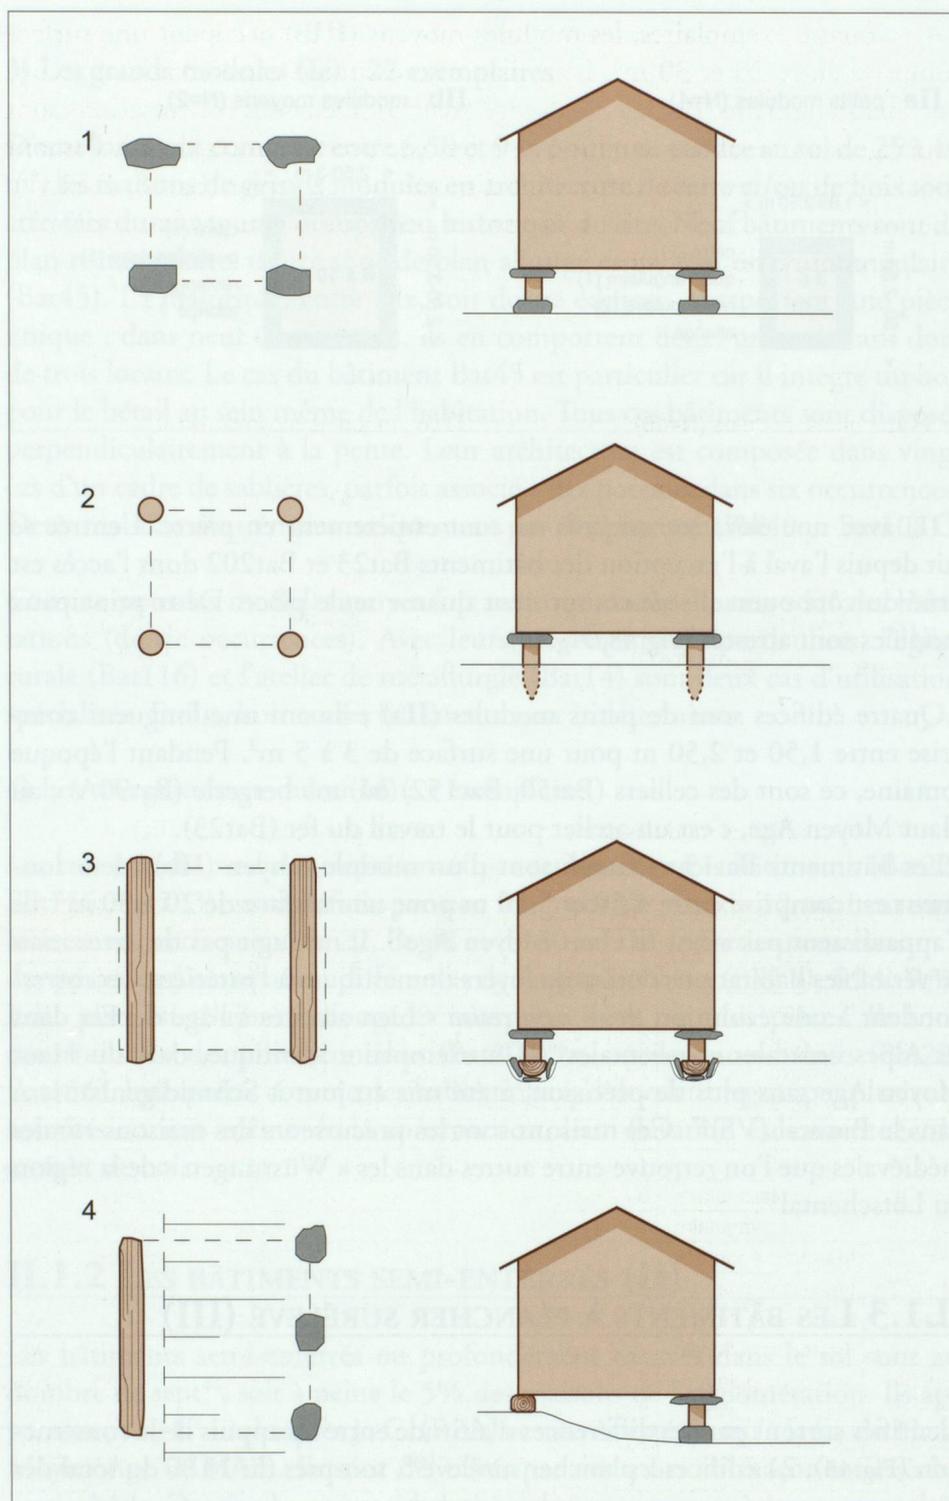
Les différents types d'implantation des bâtiments à plancher surélevé (en plan et en coupe). 1. sur pierres de soubassement (B1), 2. sur poteaux (C), 3. sur solins enterrés (B3), 4. Appuis mixtes.
